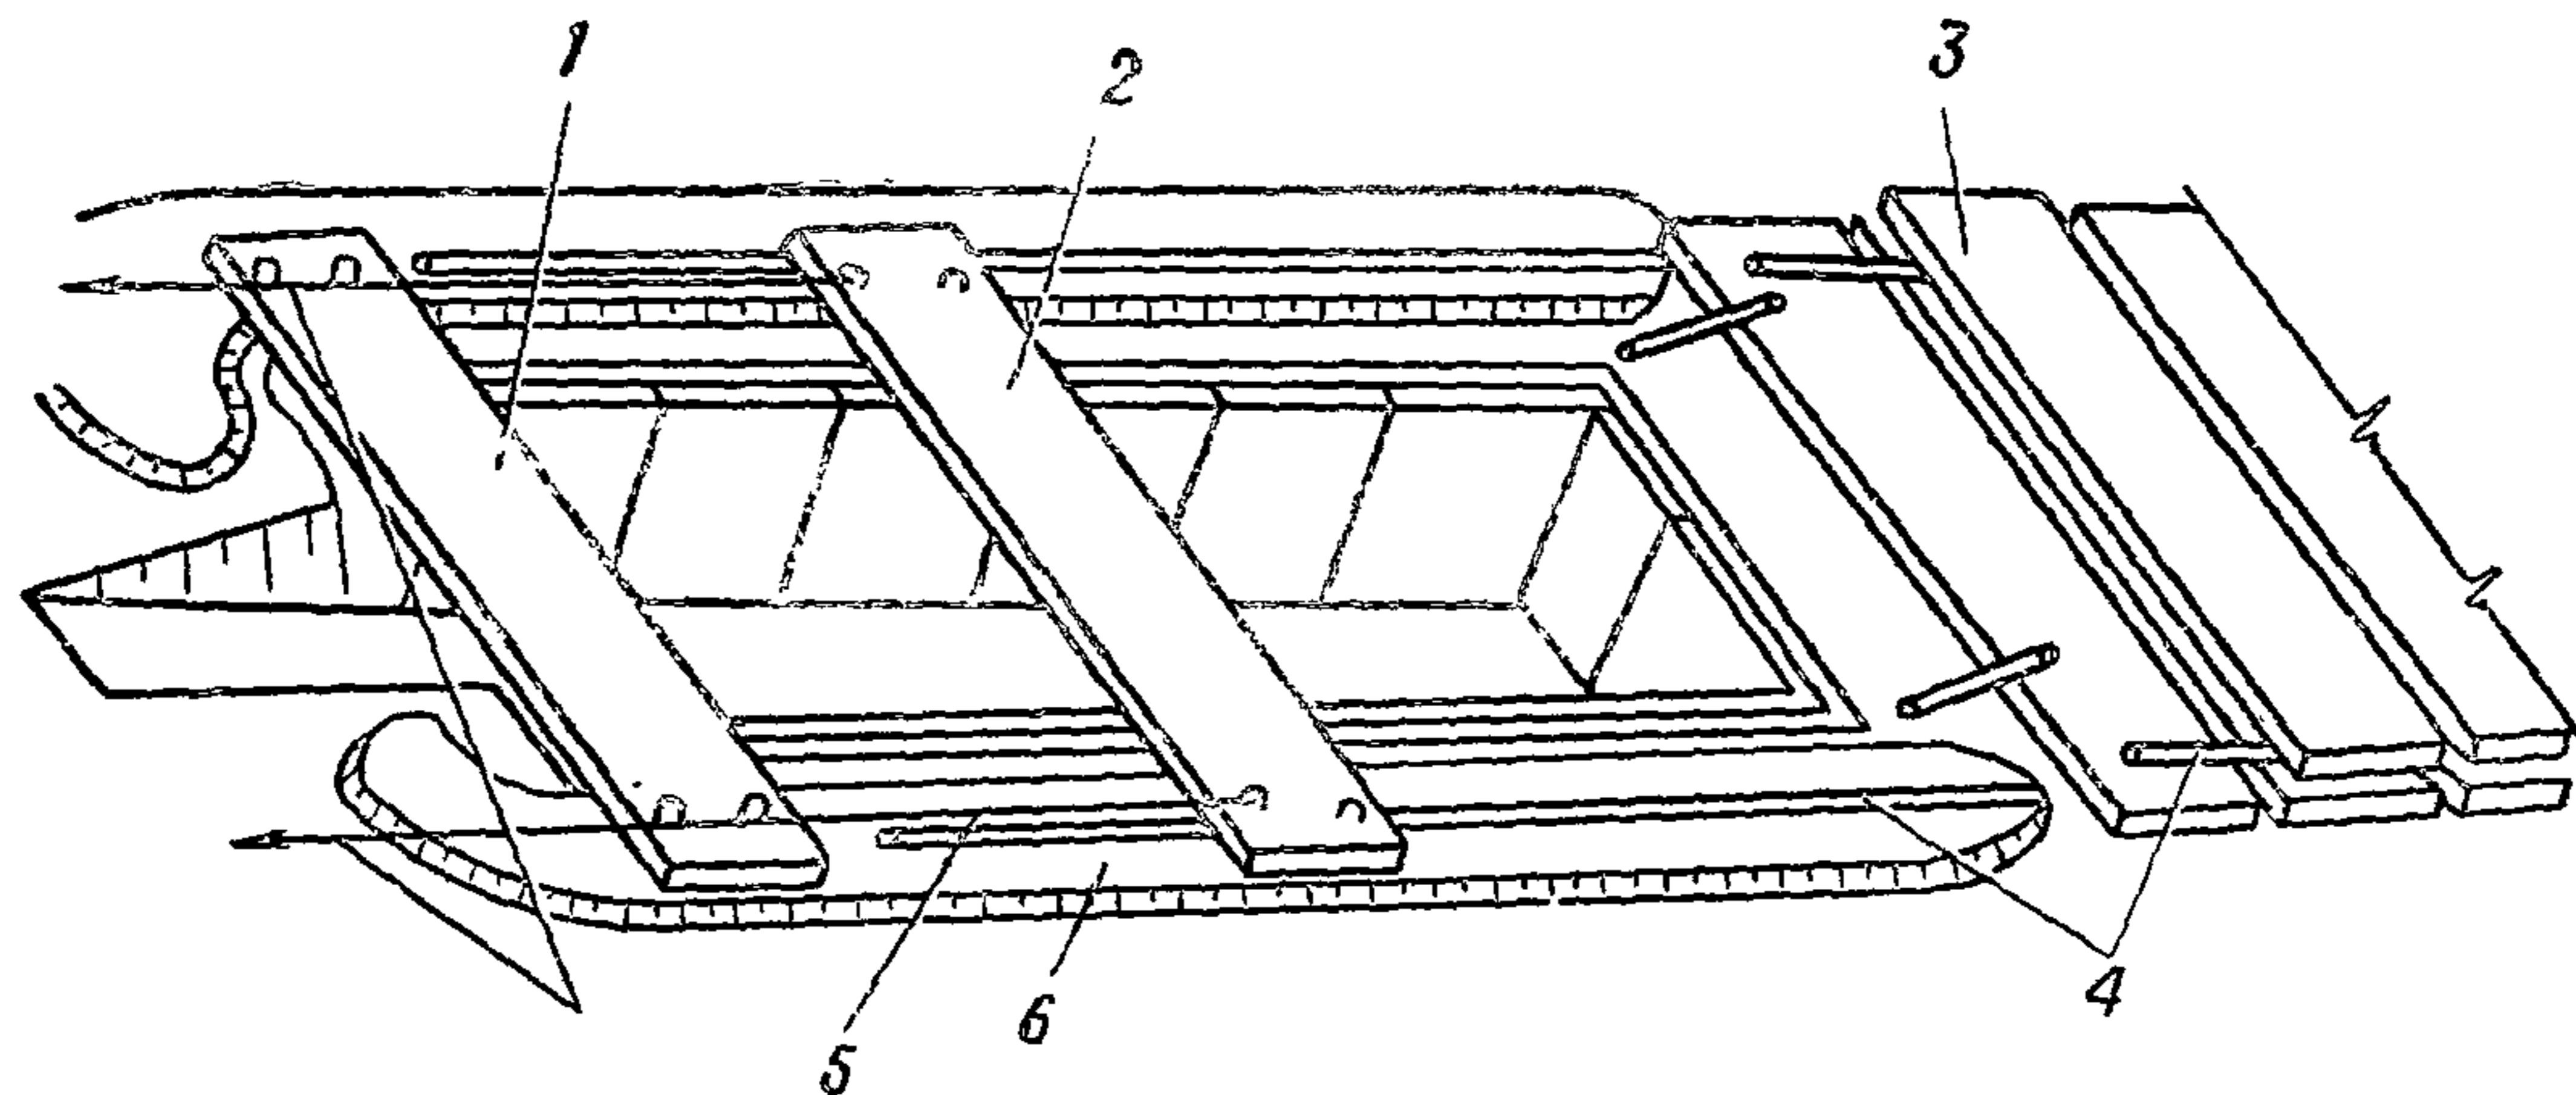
Схема укладки плит покрытия вручную способом надвигки:
